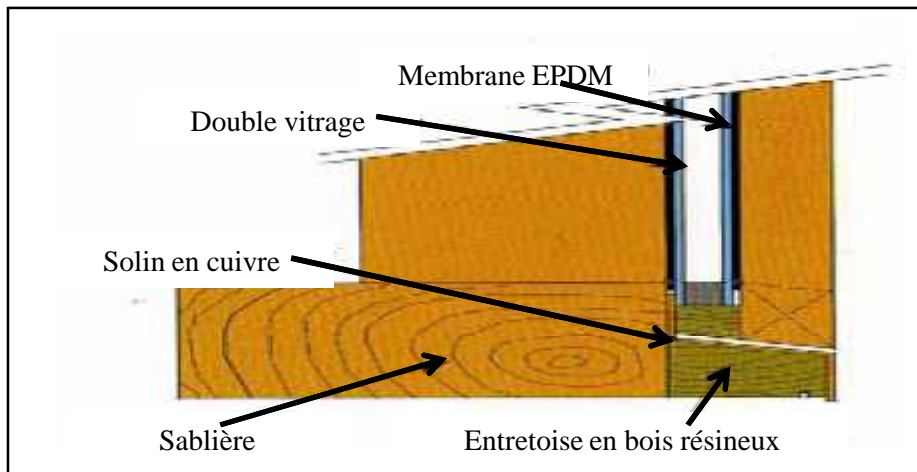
vue en coupe d'une sablière ou lisse haute
